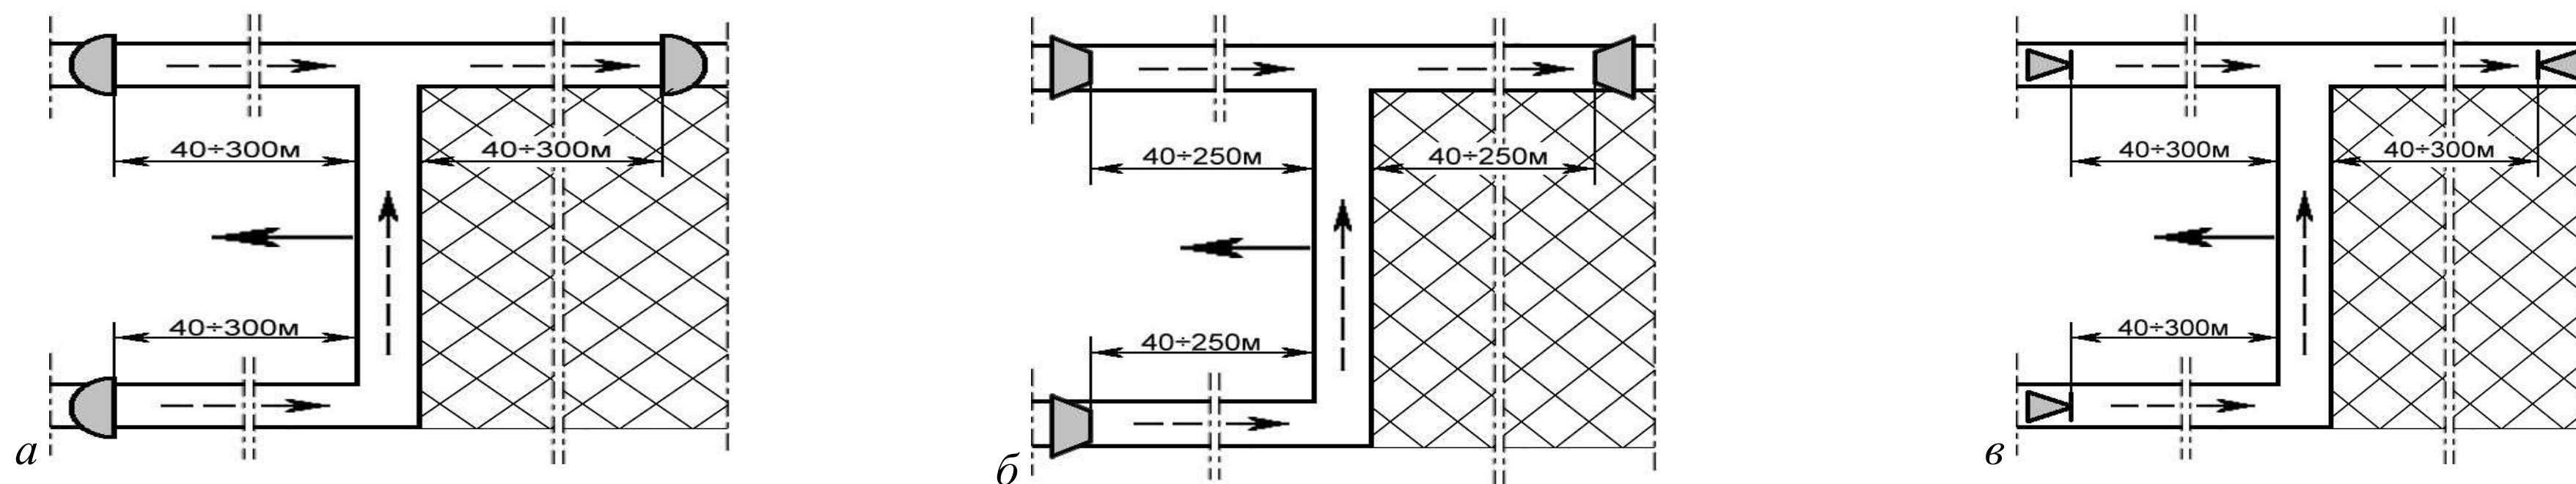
Схемы установки заслонов от сопряжения с очистной выработкой в конвейерной выработке и в вентиляционной выработке, по которой отводится вентиляционная струя при прямоточных с подсвежением схемах проветривания
